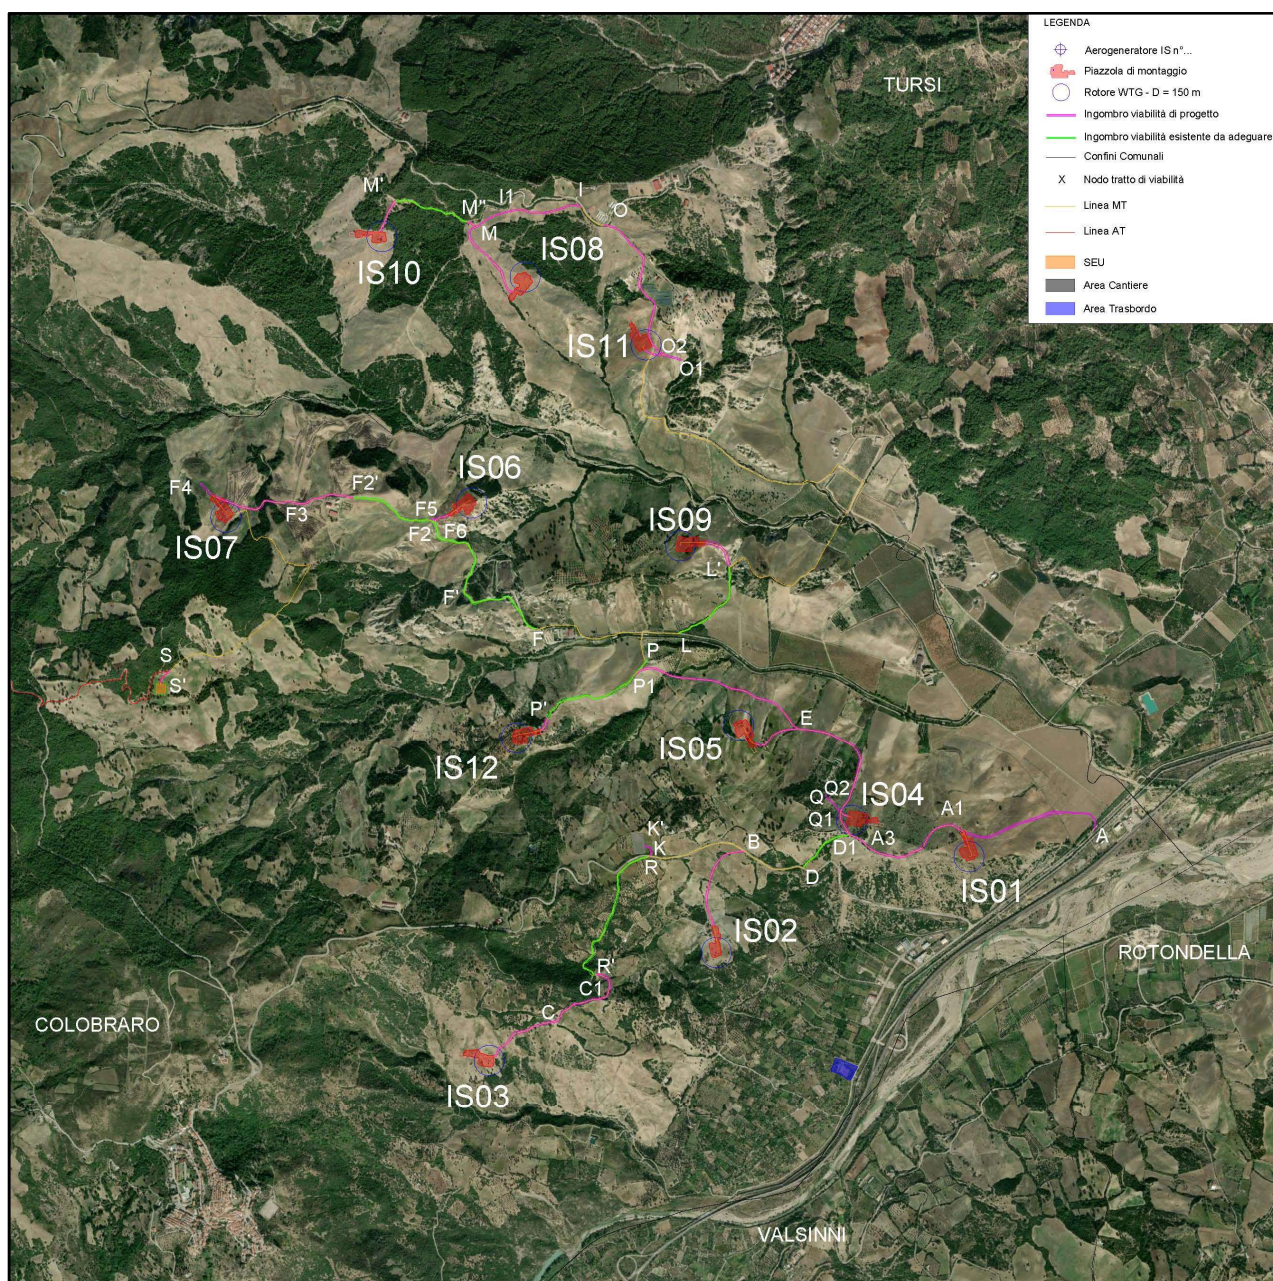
Planimetria viabilità in fase di costruzione e montaggio
